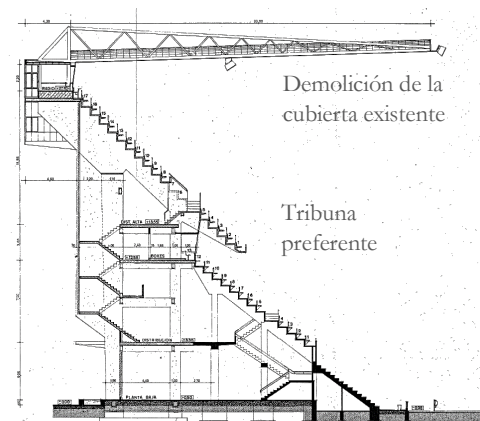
Actuación en zona preferente (sur), apoyo de la nueva cubierta sobre el graderío existente
